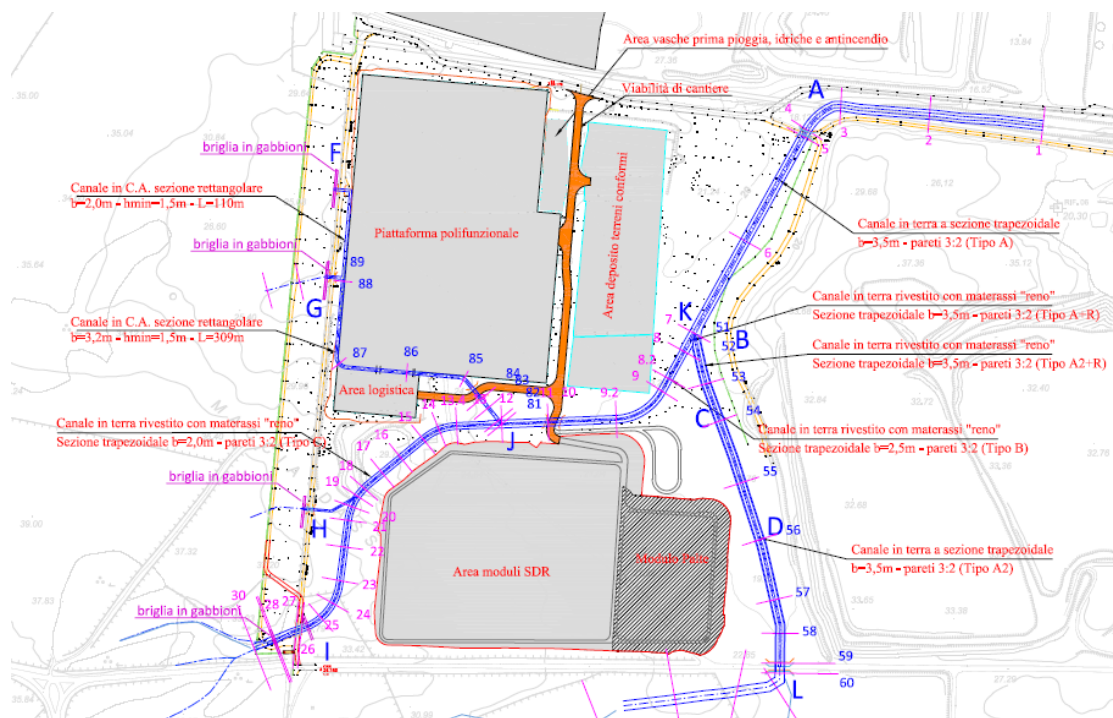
Planimetria degli interventi eseguiti, previsti dal progetto
